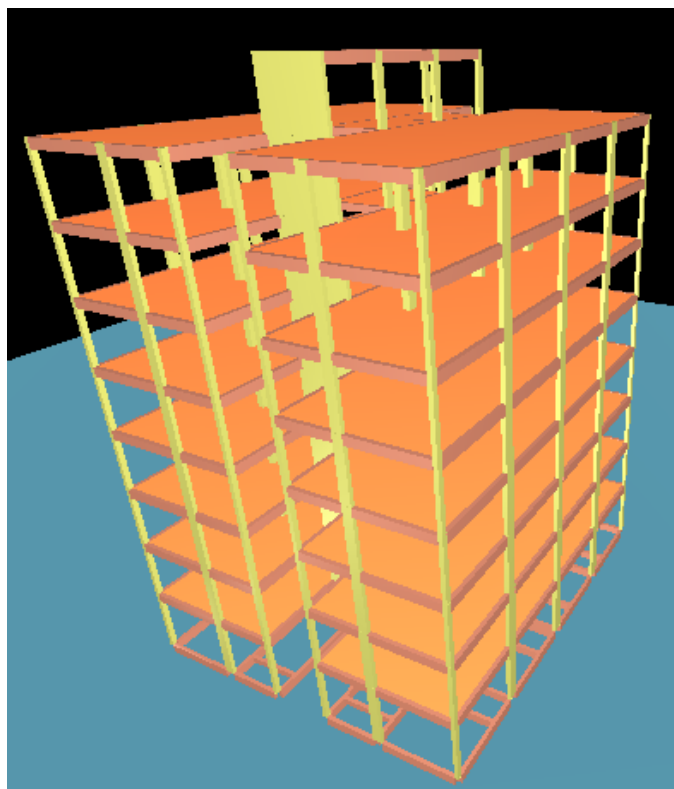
Sistema de pórtico tridimensional da estrutura de Lajes Lisas vinculada a um núcleo rígido -
